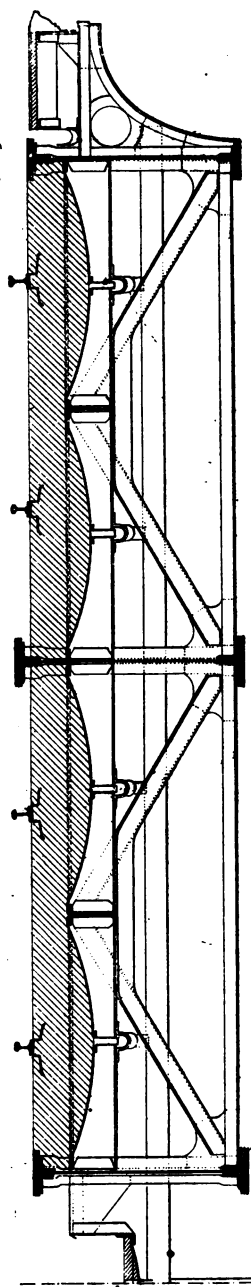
Coupe du passage inférieur de la rue Meyer.
